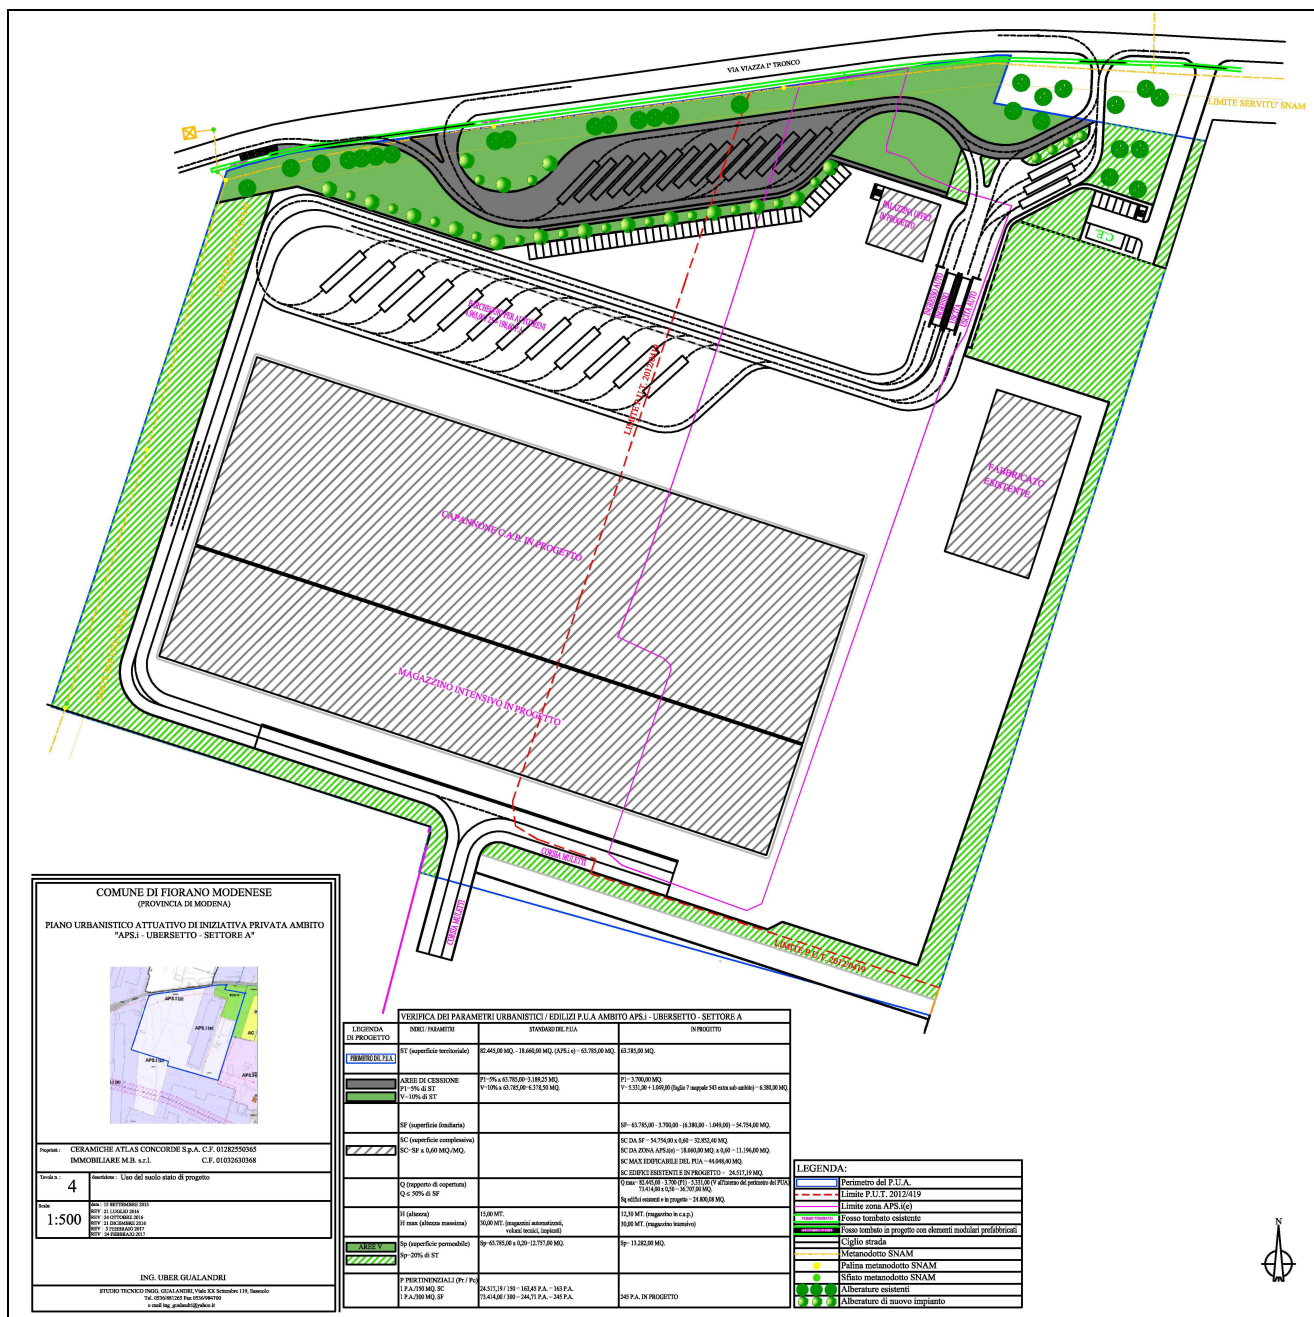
Planimetria schematica del nuovo magazzino (Tav. 4)
